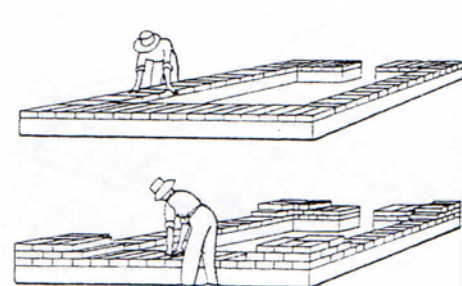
Construcción de muros de adobe. Fuente: CRATerre. (1990). Construir con tierra.
